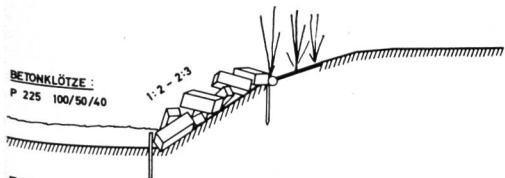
Betonklötzverbauung mit Holzabdeckung; Masstab 1:200
